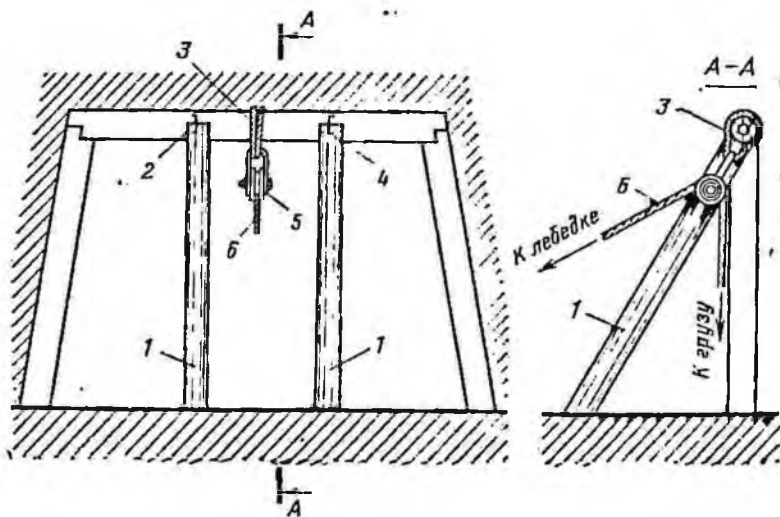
Схема подвески монтажного блока на верхняк из дерева:
